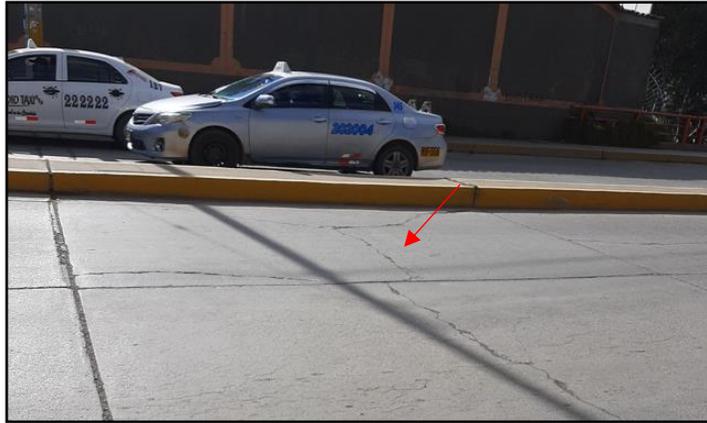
Ejemplo de fisuración– HUANCAYO.
